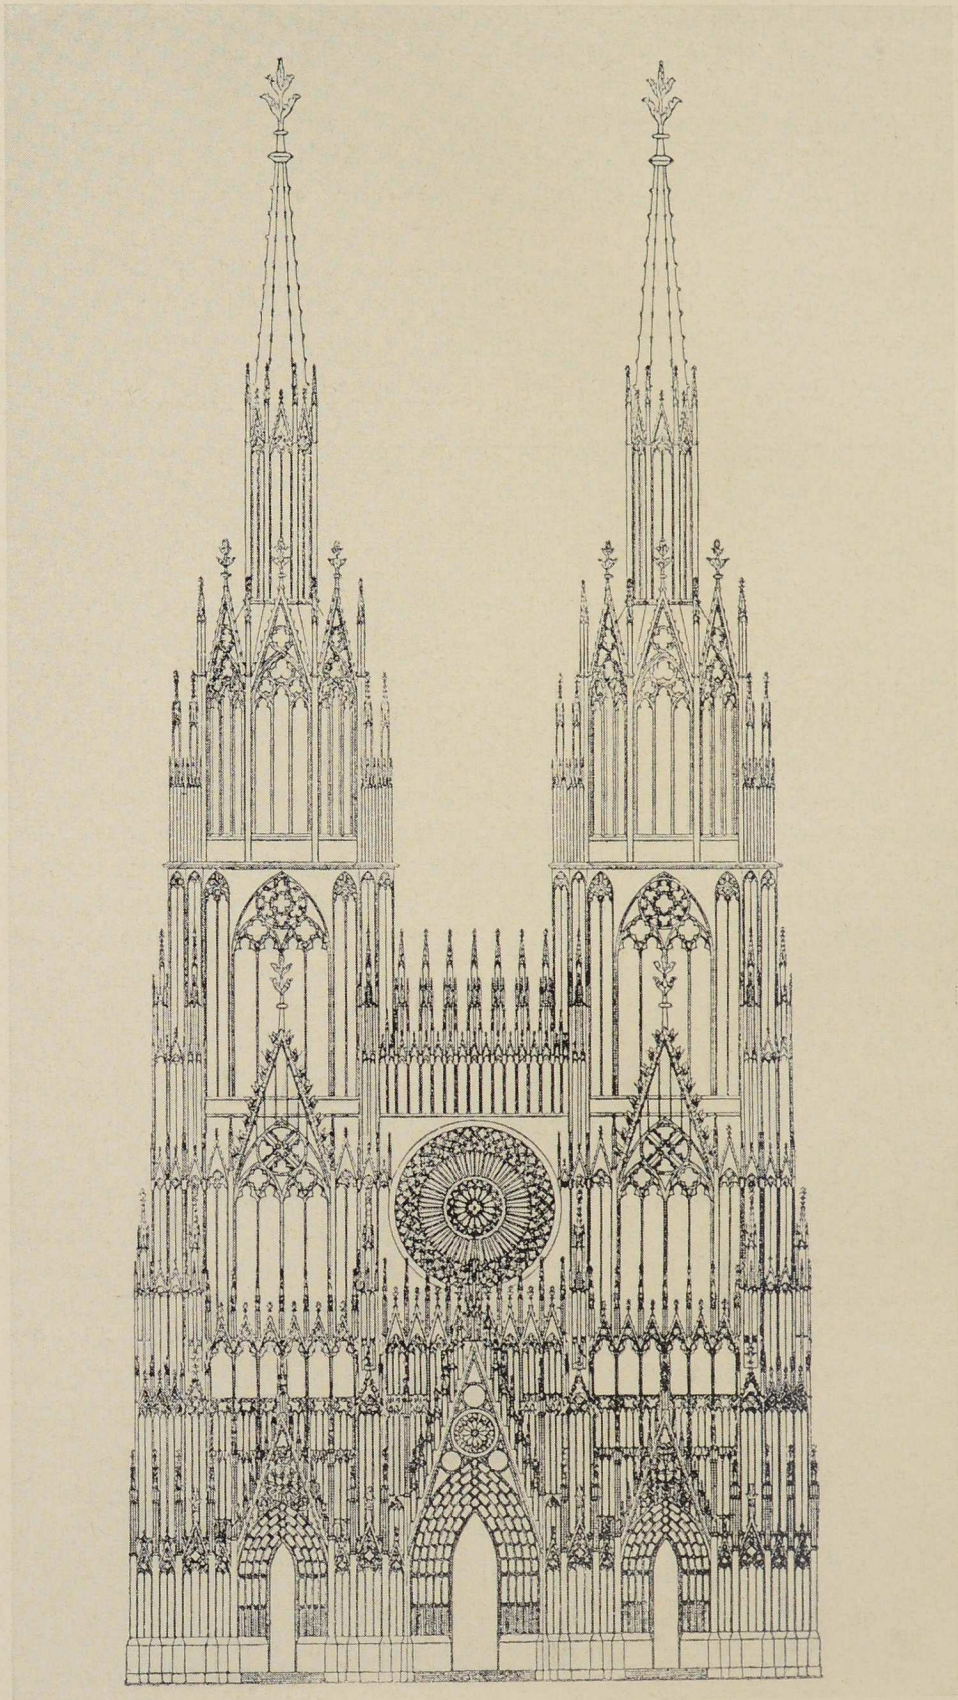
Straßburg, Entwurf zur Westfassade des Münsters, Riß B
